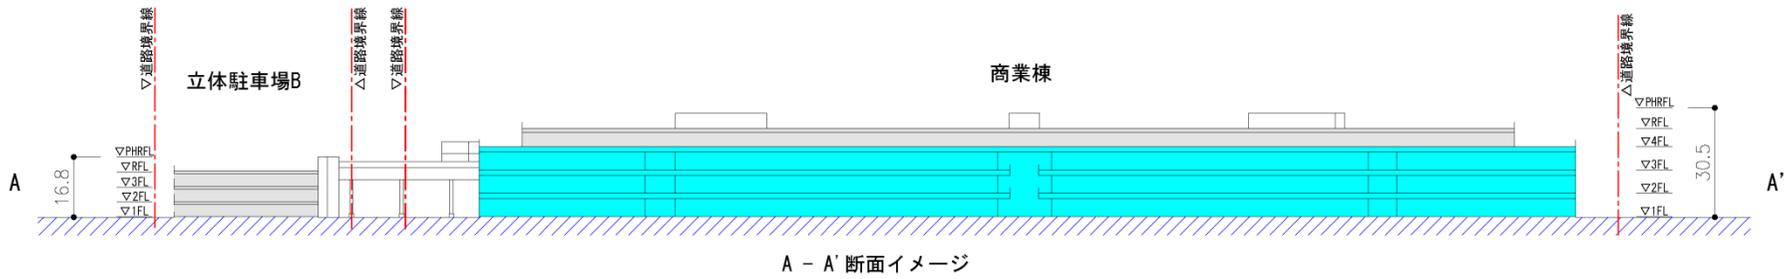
(2) 施設配置計画案 1 (断面図) (配慮計画書から引用)
